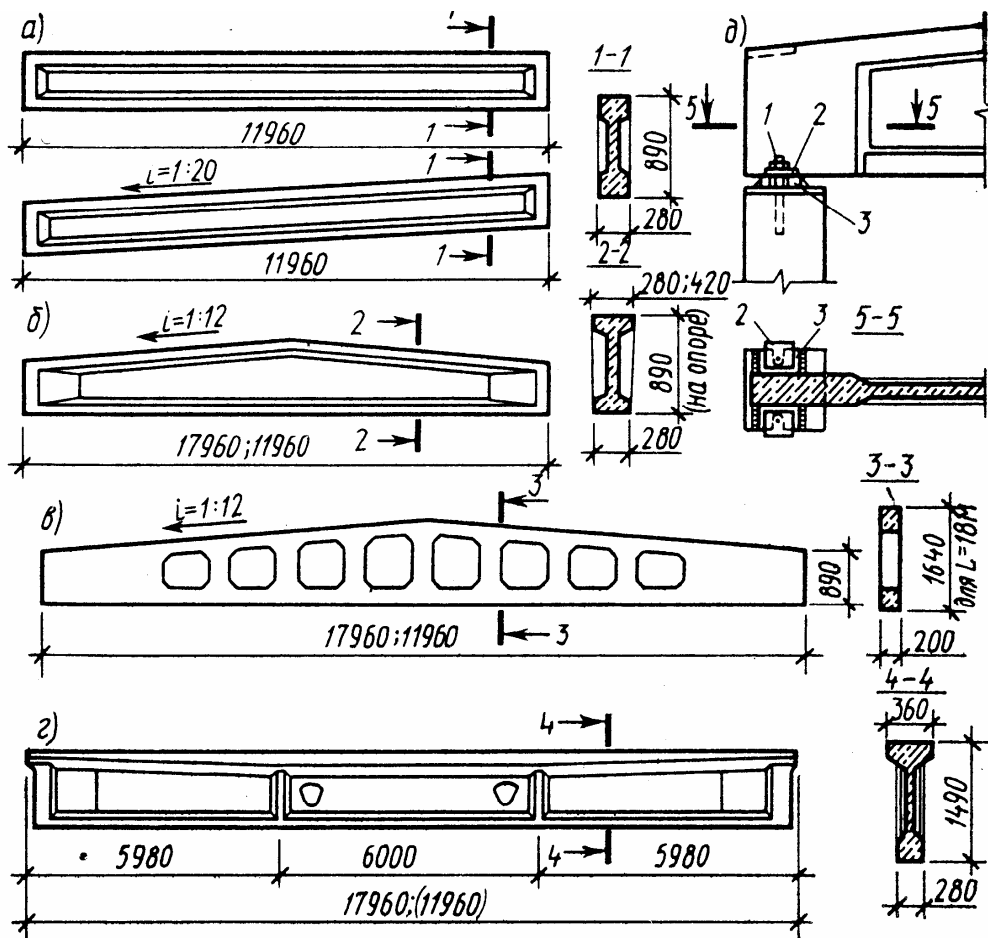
Железобетонные балки: односкатная (а), двускатная (б, в), горизонтальная (г)
